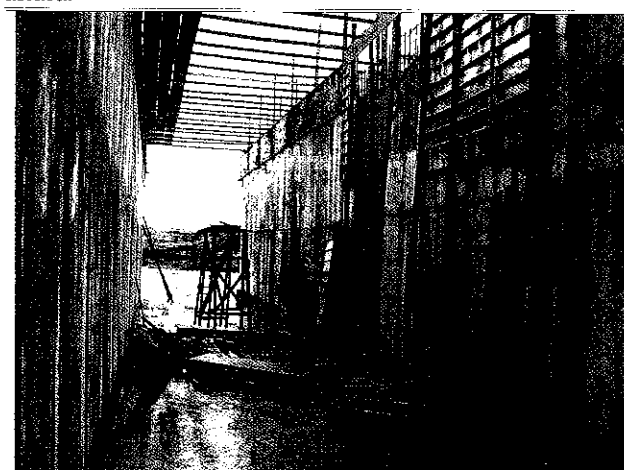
Interior da estrutura do piloto do sistema de transposição de peixes (STP).
